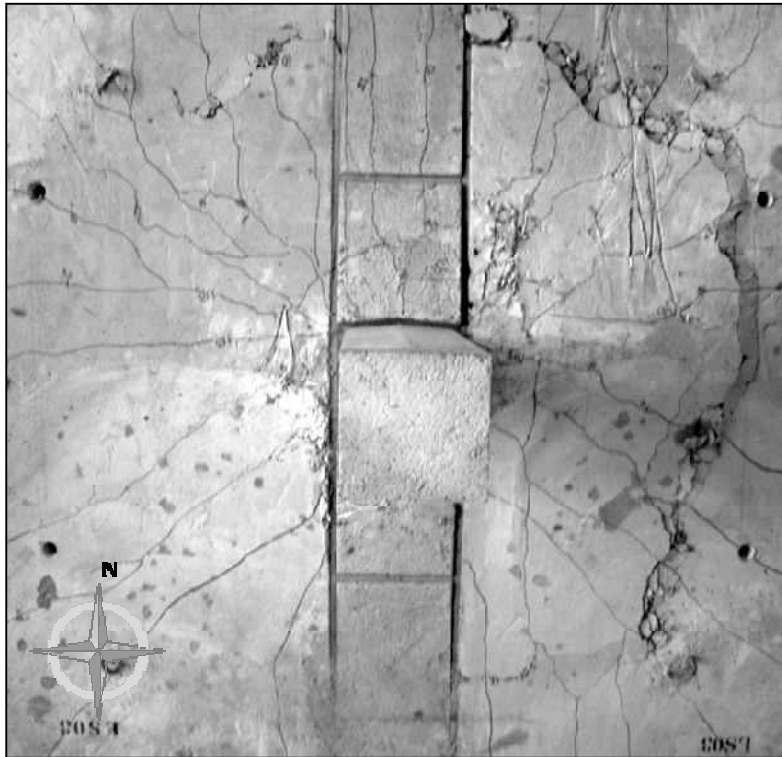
Mapa de fissuração da laje LS03
